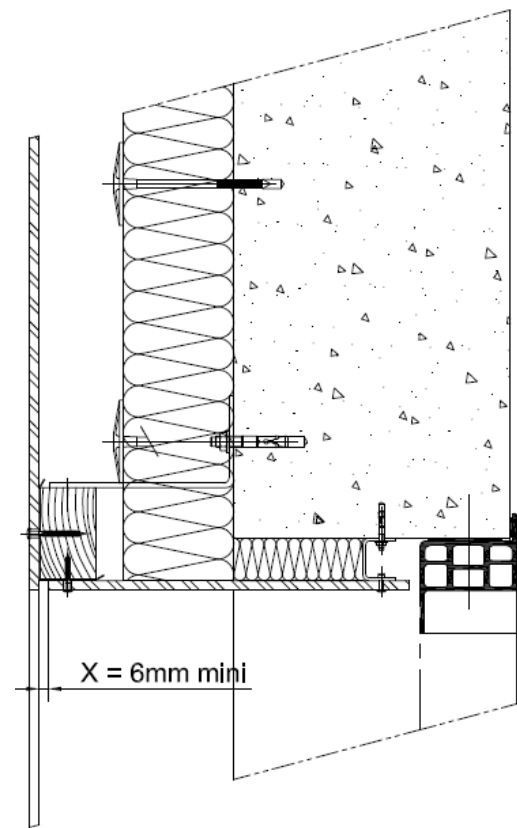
Sección horizontal. Detalle de telar de jamba.
